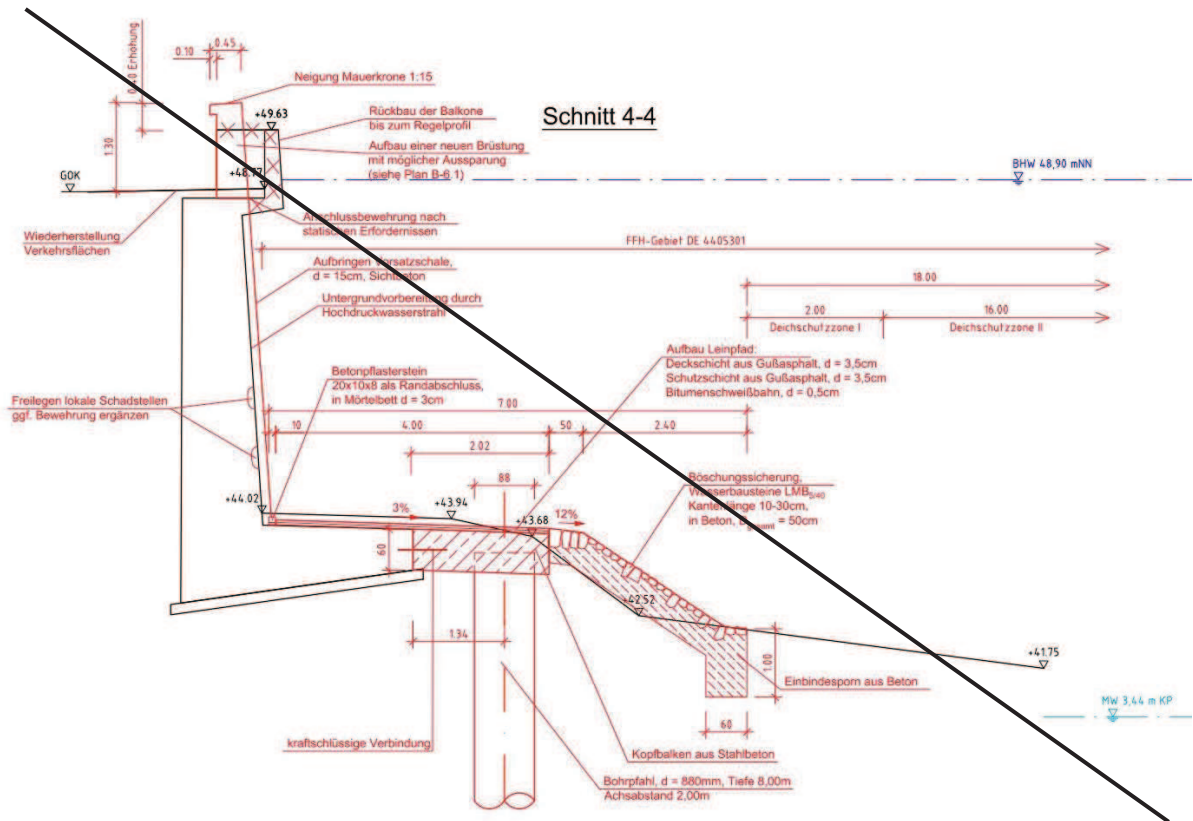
Detailausschnitt Sanierung Brüstung und wasserseitige Wandfläche
